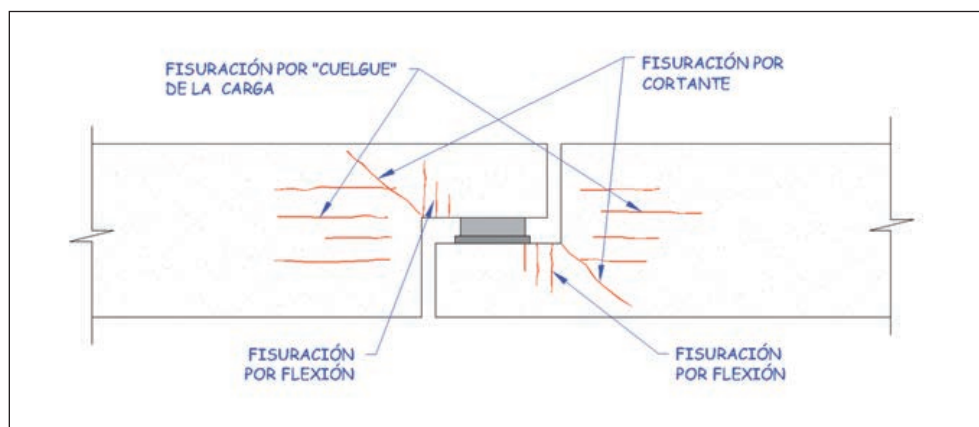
ESQUEMAS DE FISURACIÓN EN UN APOYO A MEDIA MADERA.
